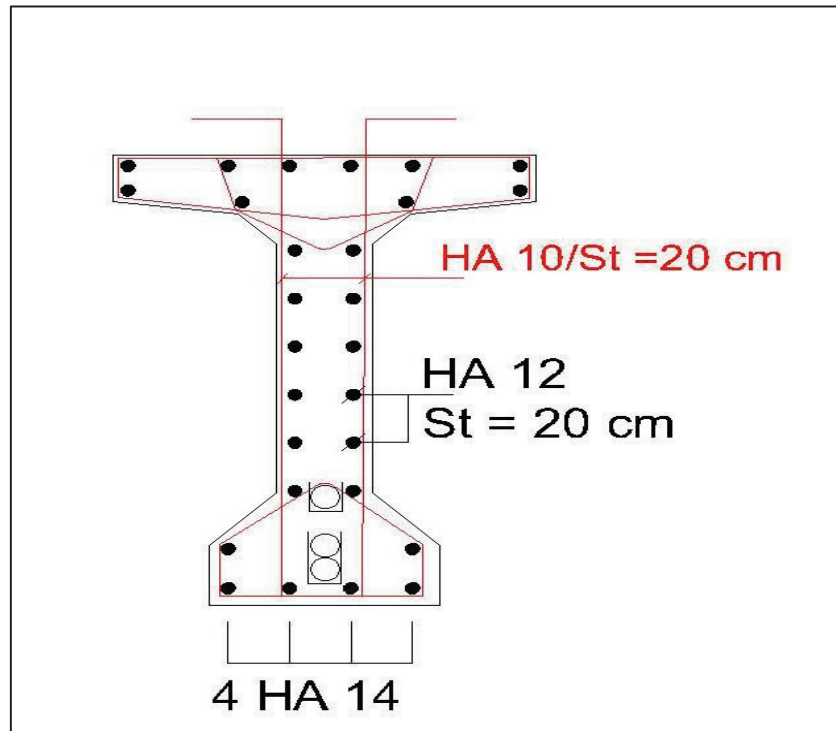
Croquis du ferrailage de la poutre en section médiane
